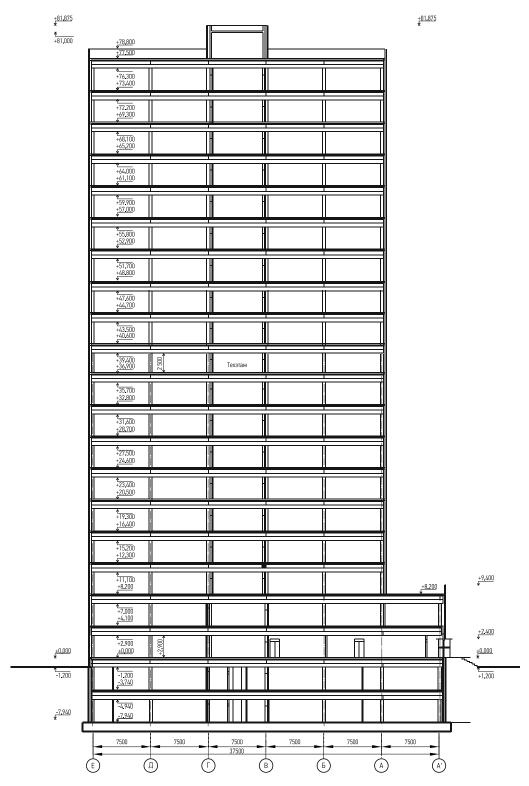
Поперечный разрез здания при короткопролетной схеме каркаса
